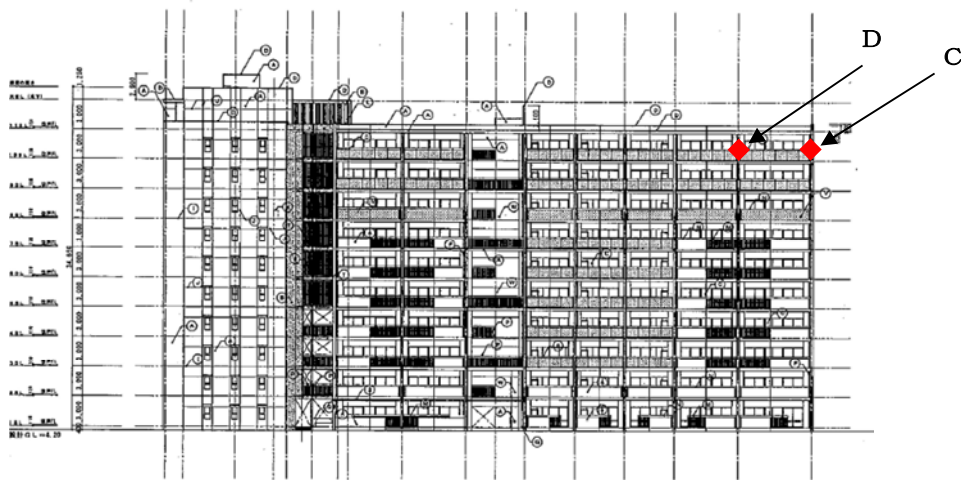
南棟：東側立面図（東面バルコニー側）
